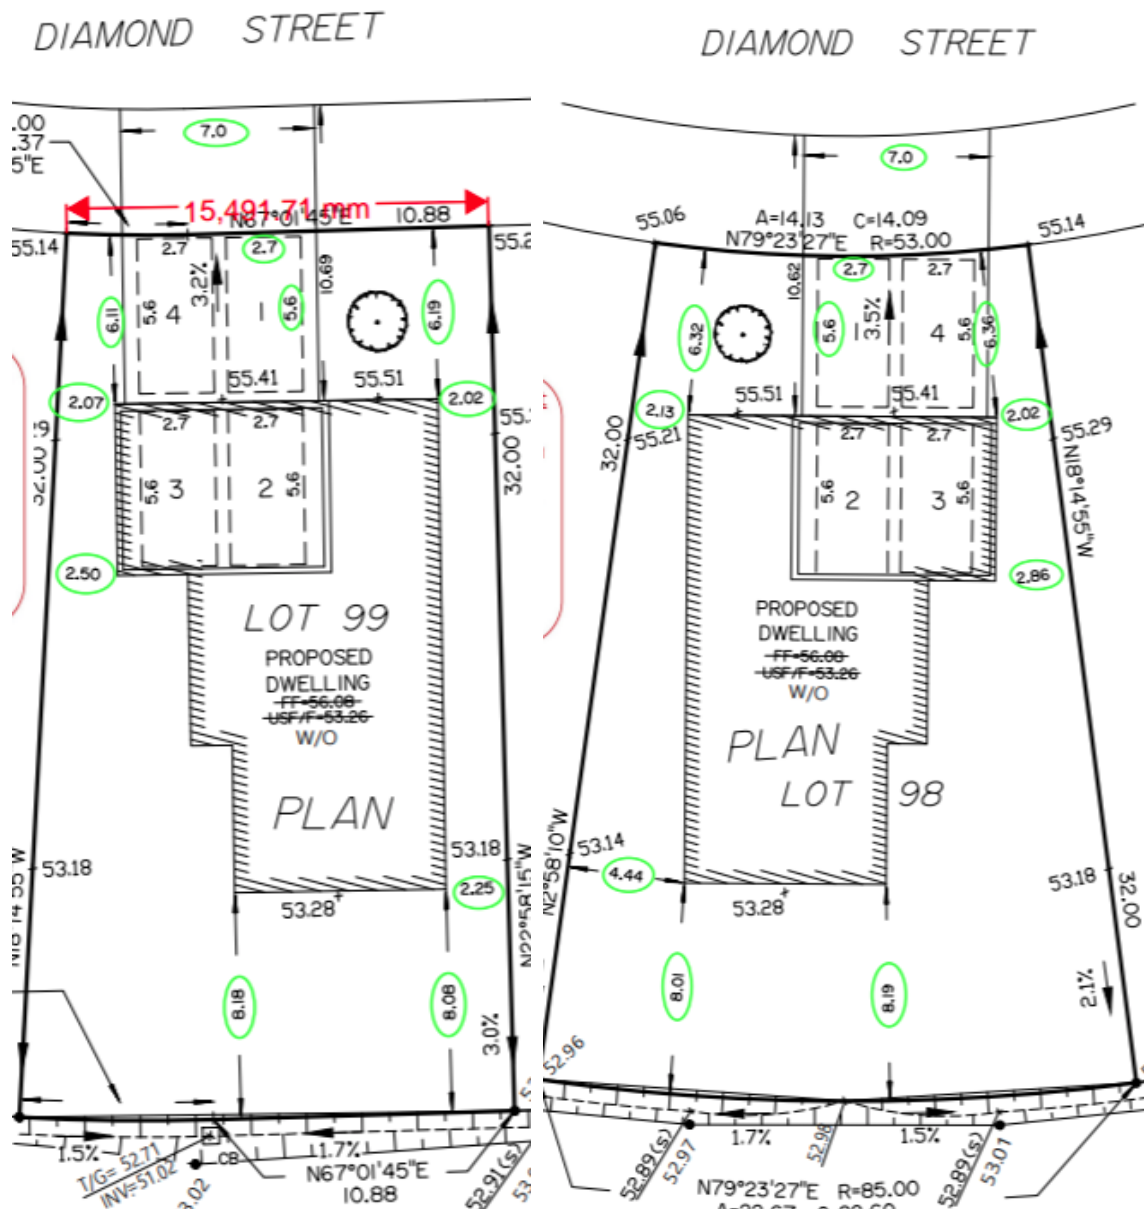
Illustration de la configuration des quatre cases en tandem sur le plan d'implantation du dossier de permis de construction pour chaque lot.
